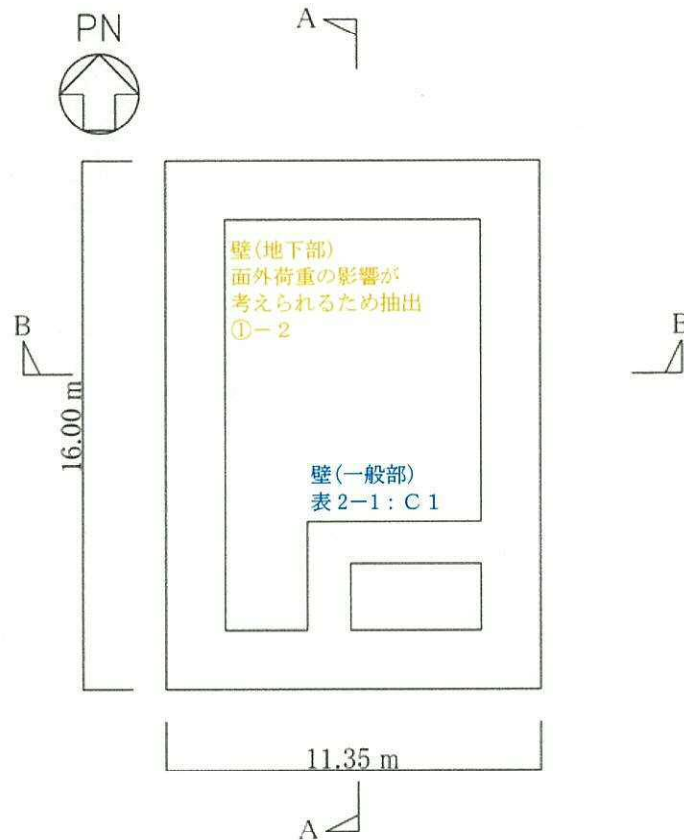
格納容器圧力逃がし装置格納槽の概略平面図 (EL. -12.8 m)
